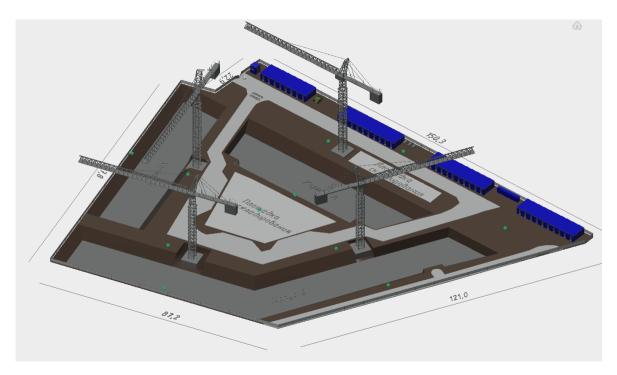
ТИМ-модель строительной площадки ЖК «Пулковский дом»
